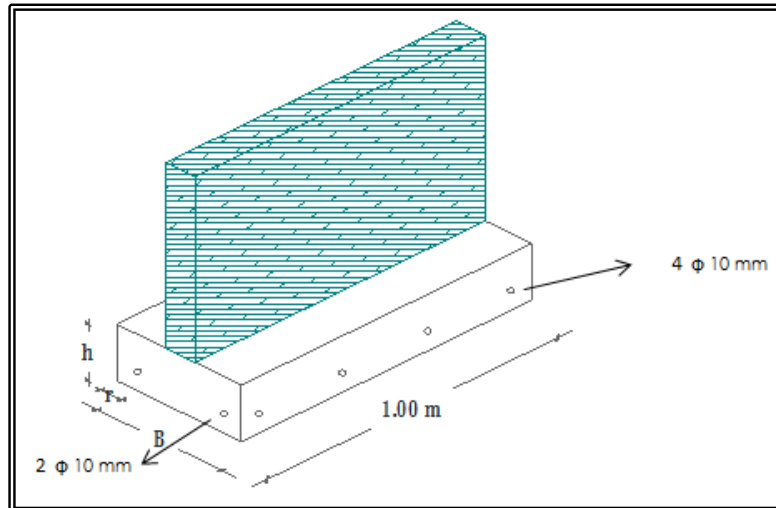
Cuantía de Refuerzo para la Zapata Corrida
